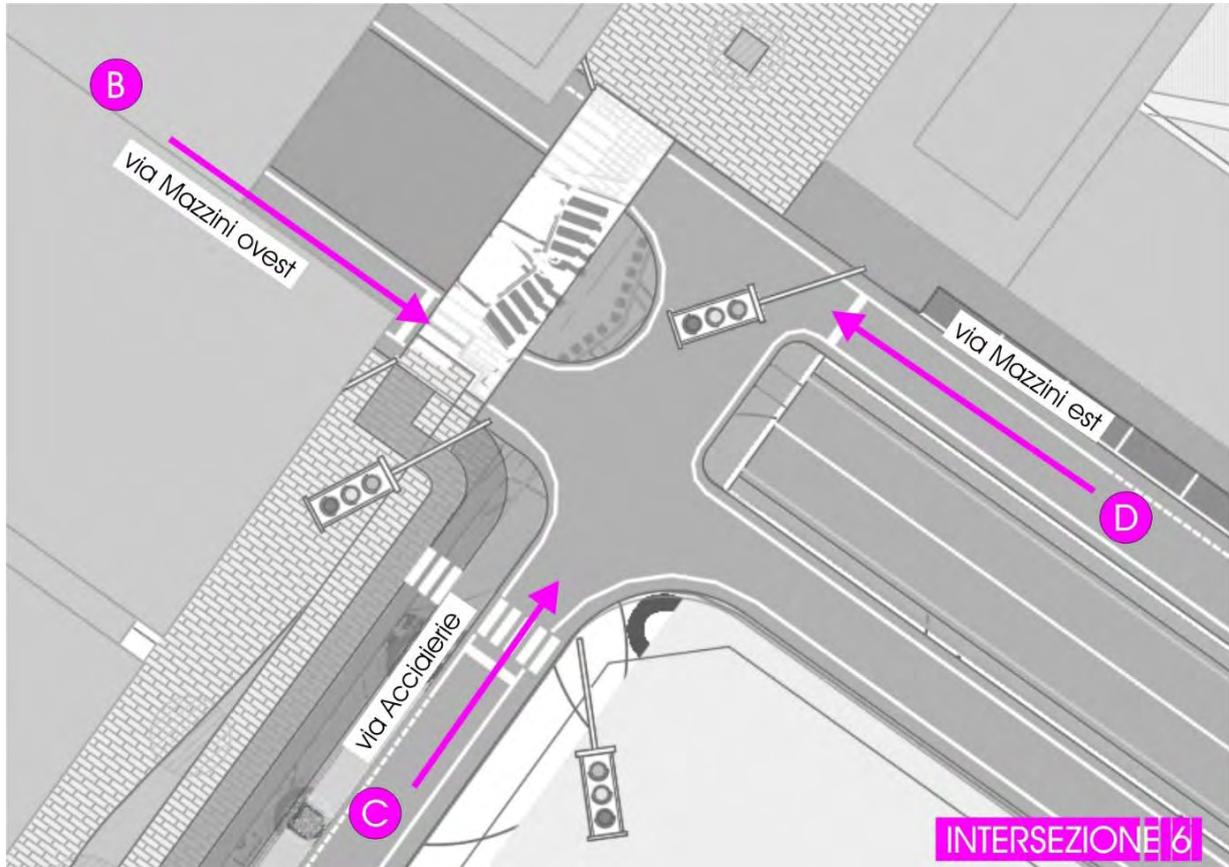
Scenario di Intervento 2 – Planimetria intersezione 6
